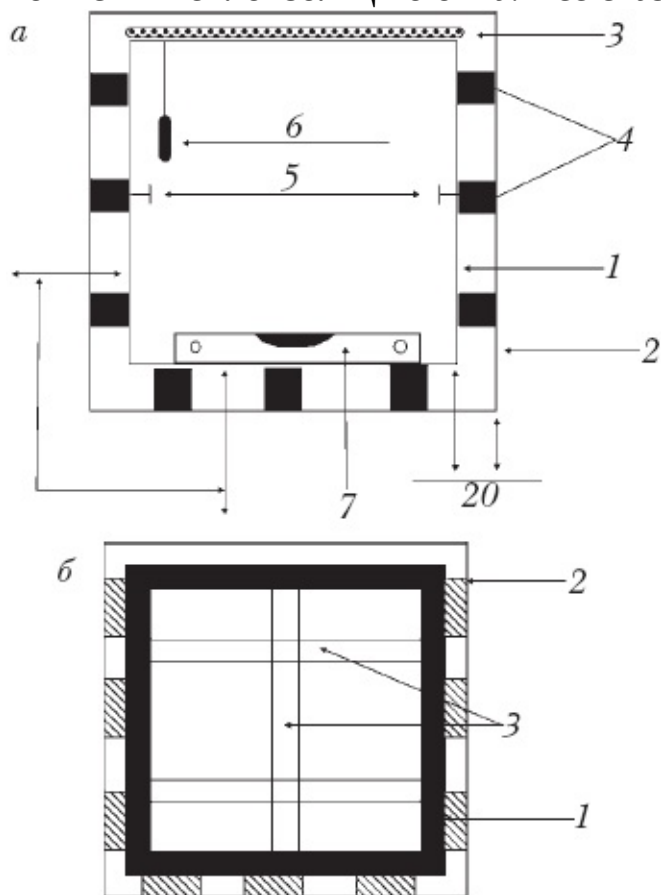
Монтаж оконного блока (размеры указаны в миллиметрах): а) – установка коробки в проем: 1 – оконная коробка; 2 – оконный проем; 3 – пористая резина; 4 – брусок; 5 – саморез; 6 – отвес; 7 – строительный уровень; б) – заполнение зазора монтажной пеной: 1 – оконная коробка; 2 – оконный проем; 3 – распорная рейка; 4 – монтажная пена; 5 – пористая резина
